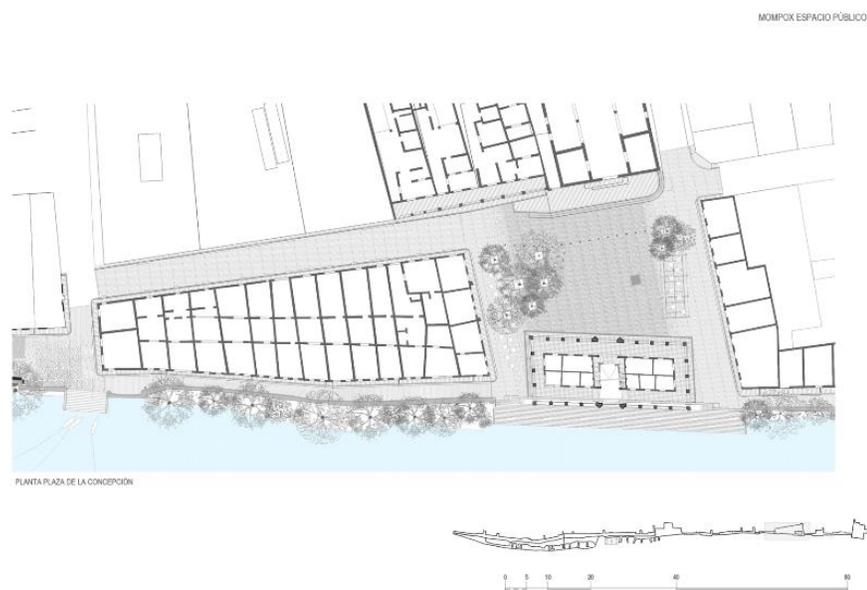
Plano Plaza de la Concepcion.. Fuente: OPUS-2014
